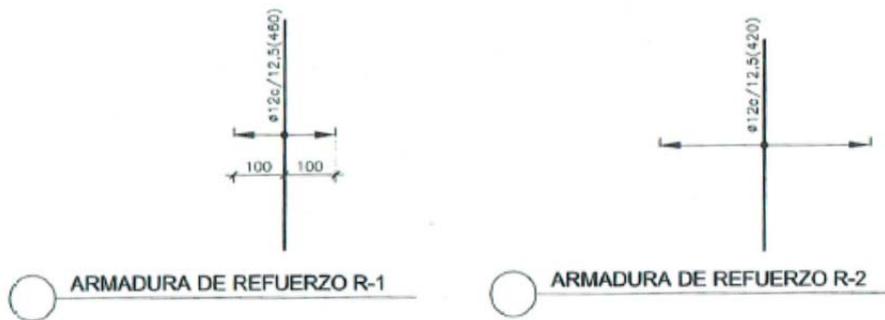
Armadura de refuerzo inferior según tipos, R-1 para bandas soporte y R-2 para bandas centrales.
